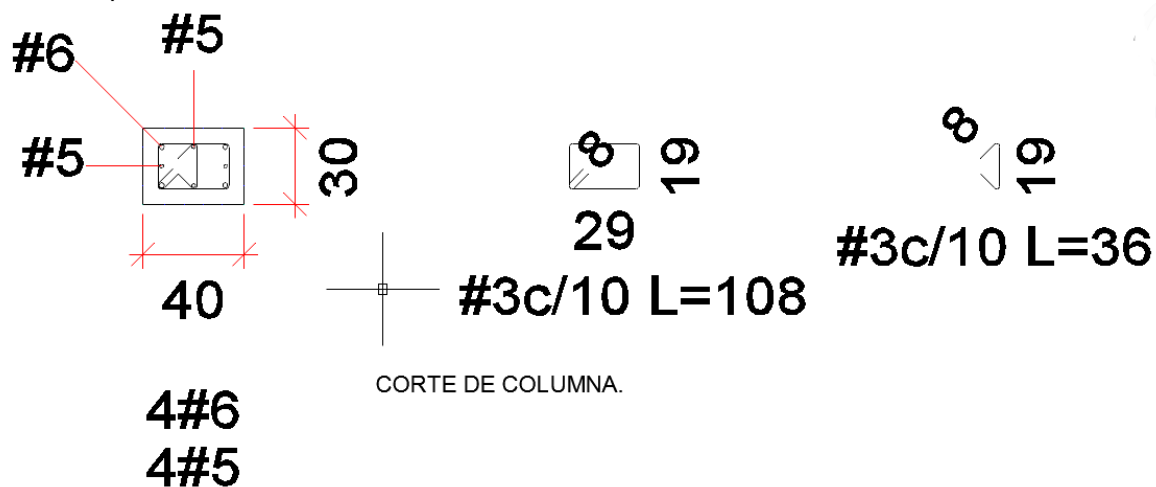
Planos de distribución de aceros en Columnas. Fuente. Arquitecto.
